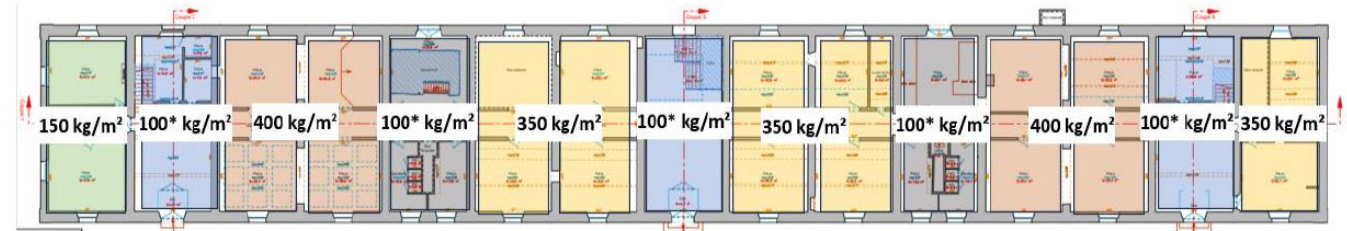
charges admissibles sur le plancher haut du RDC soit le plancher bas du R+1
